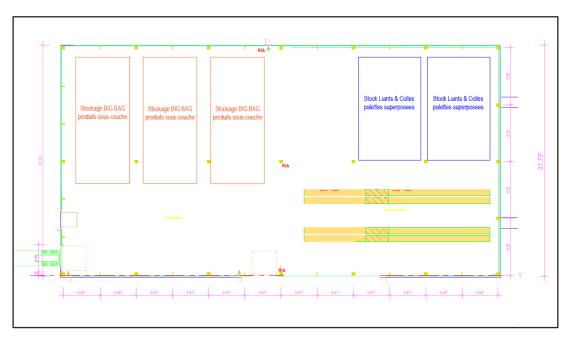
Stockage futur bâtiments (source : sicabconstruction)
